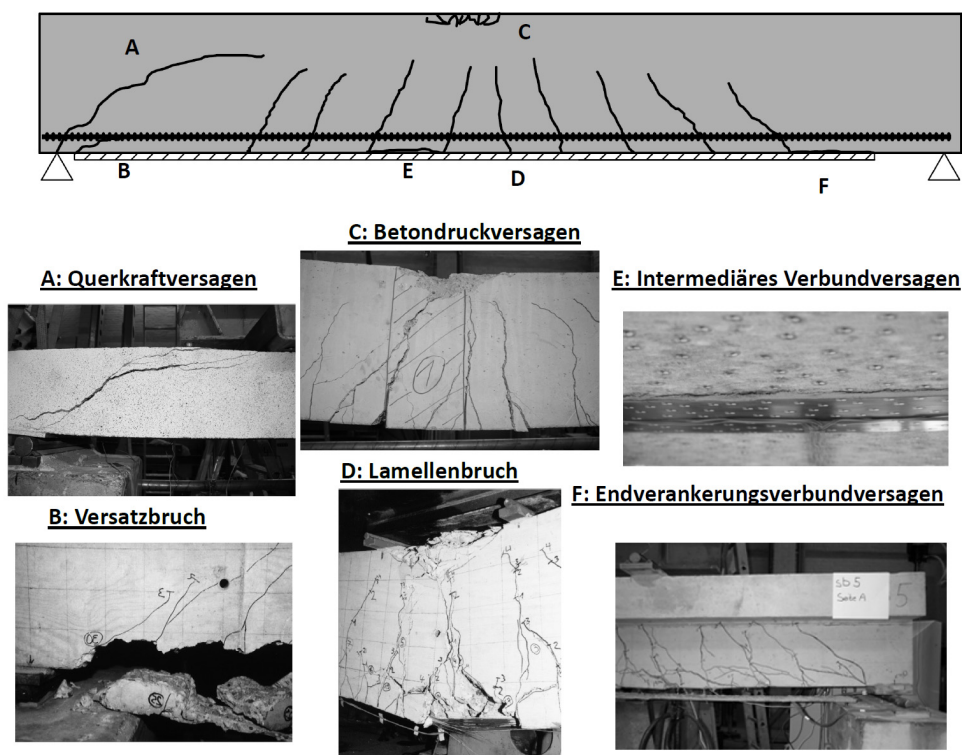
Exemplarische Darstellung der auftretenden Versagensarten eines durch geklebte Bewehrung biegeverstärkten Stahlbetonträgers
